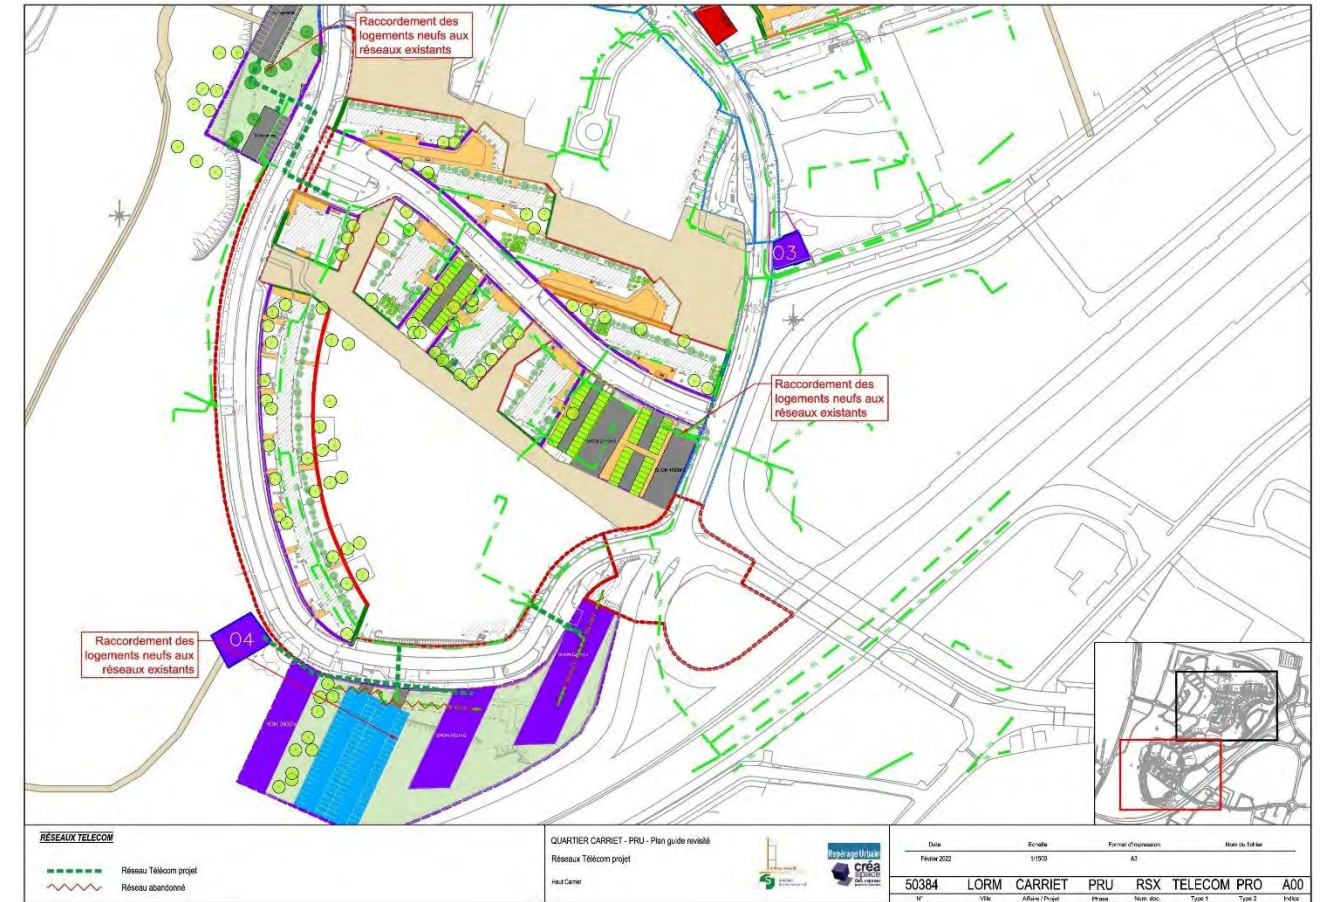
Réseaux télécom au niveau du secteur Haut Carriet sur la ville de Lormont
